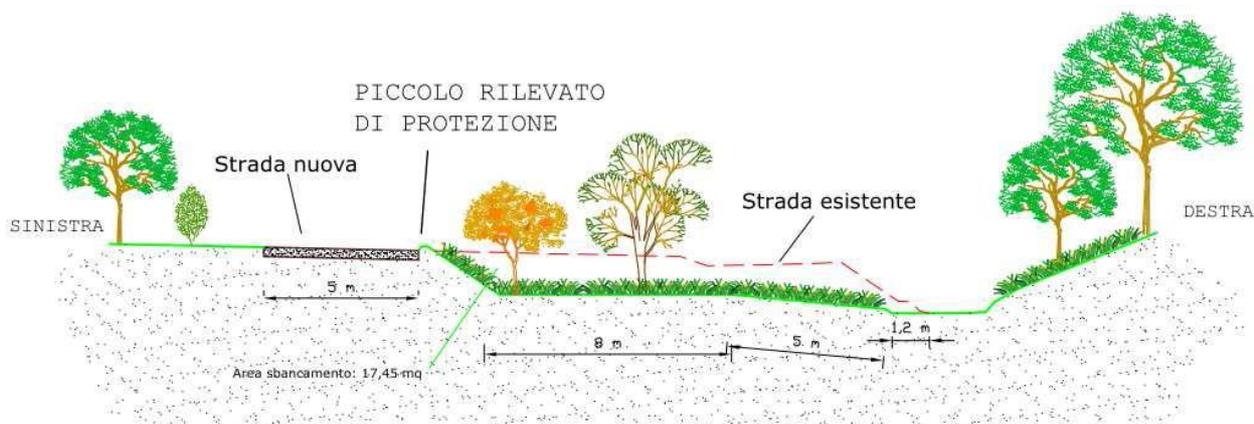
Schema progettuale di un allargamento di sezione tipo
